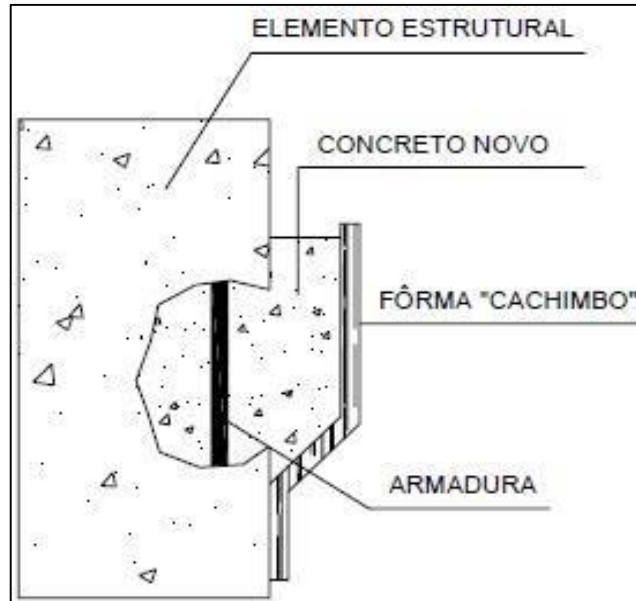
Detalhe Da Forma Tipo “Cachimbo”?
